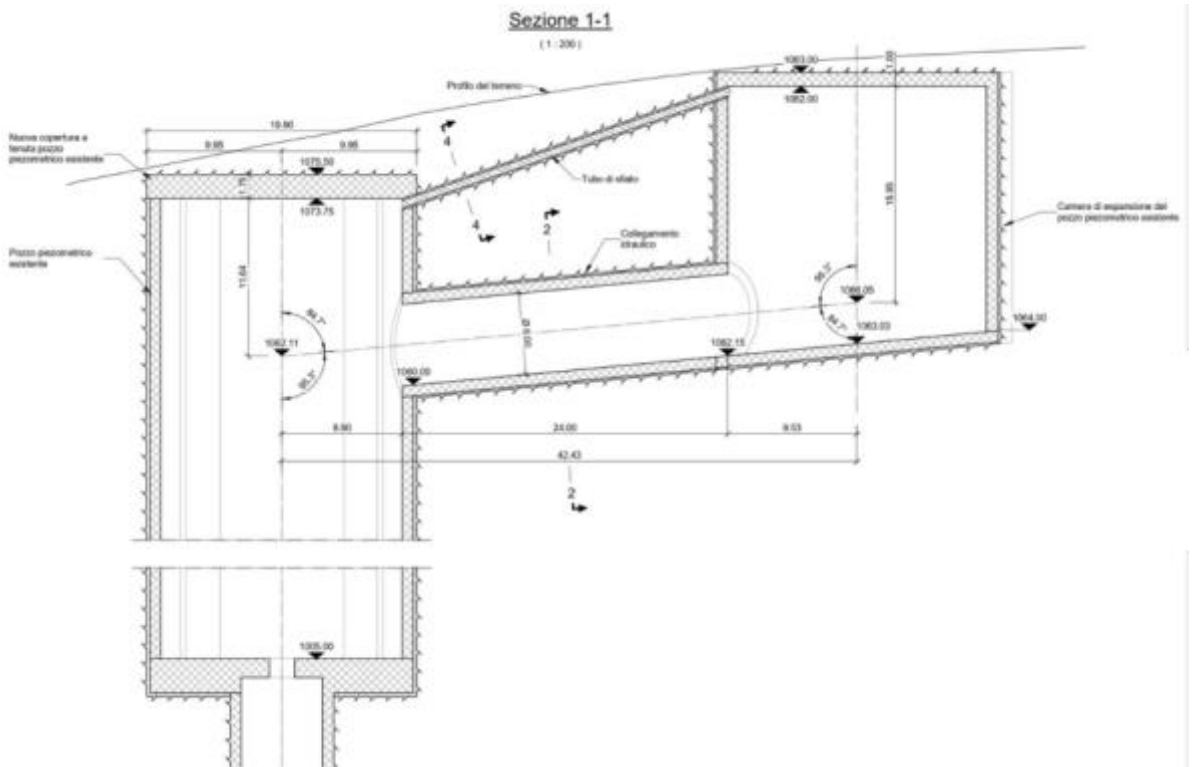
Nuova camera di espansione al pozzo piezometrico sulla derivazione Provvidenza – profilo
